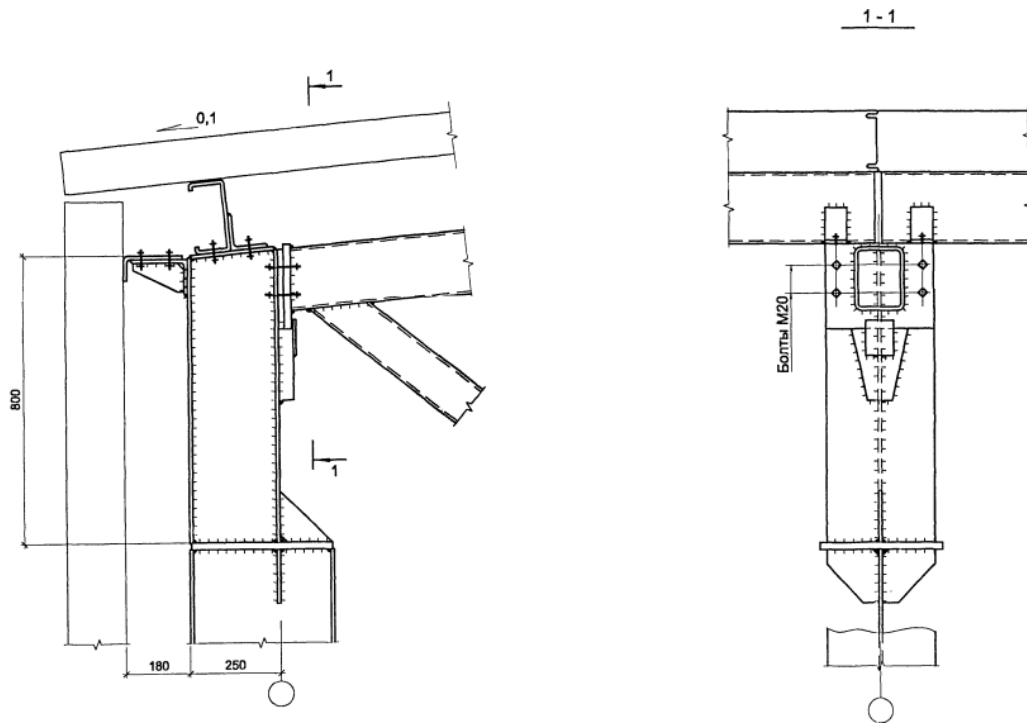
Принципиальное решение узла опирания стропильной фермы на колонну каркаса
